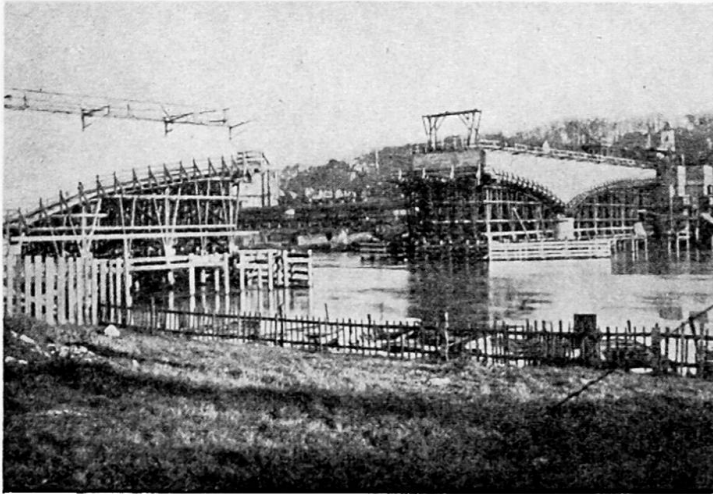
Câbles tendus à 85 tonnes. On va procéder à l'enlèvement du cintre sous console-culasse Rive-gauche
